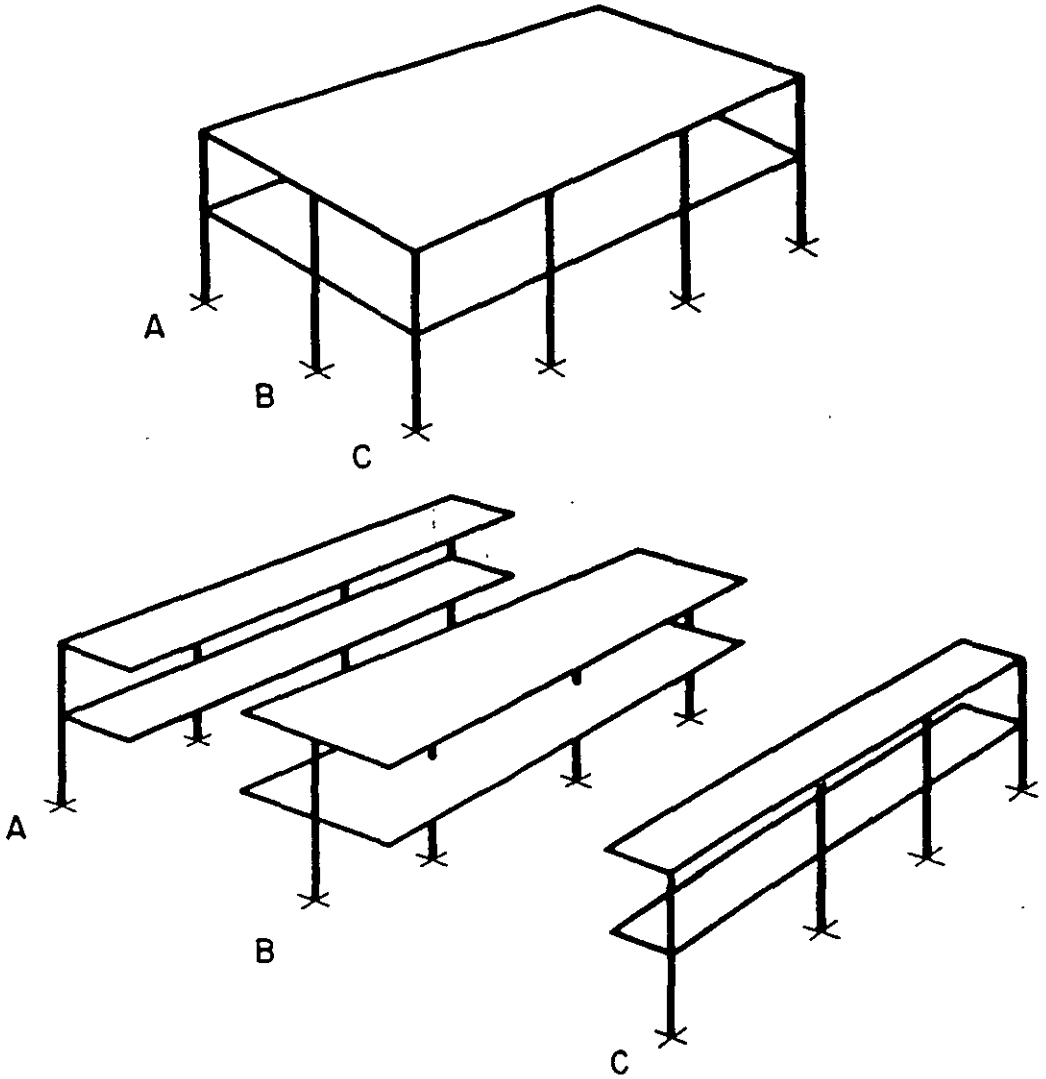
Idealización de una estructura con losa plana en la dirección longitudinal
